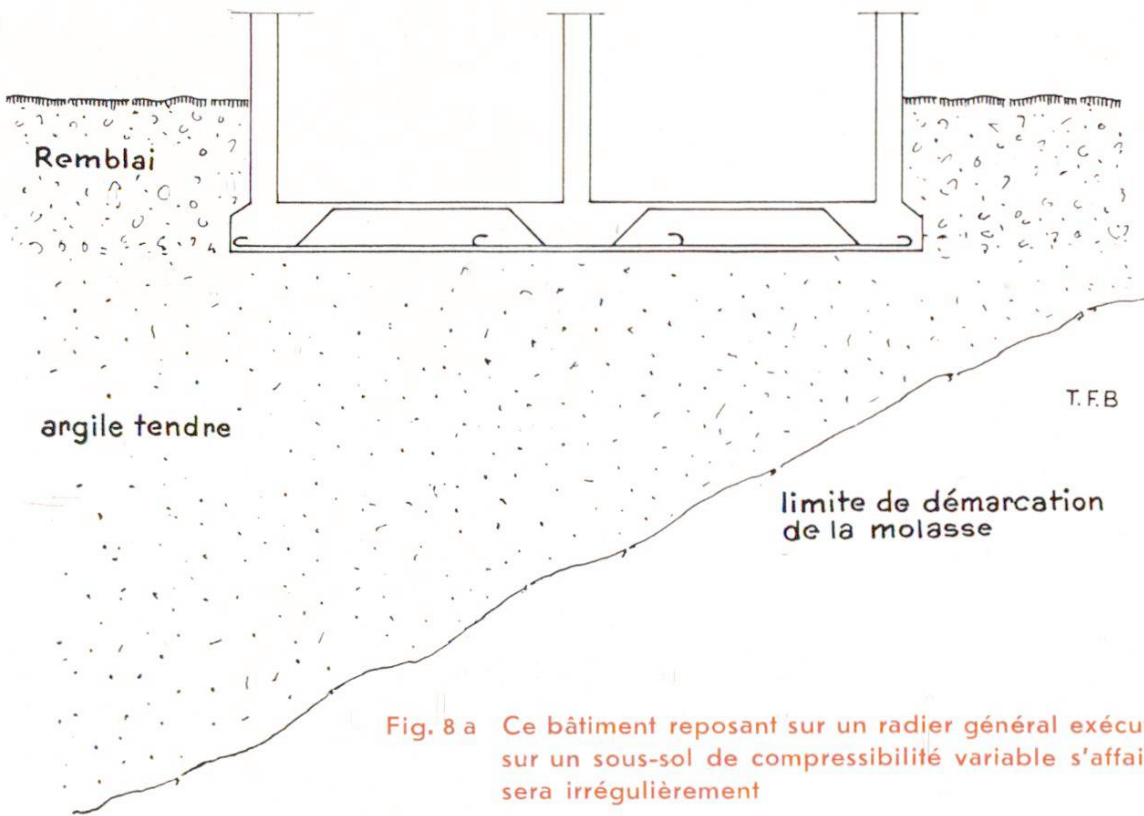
a Ce bâtiment reposant sur un radier général exécuté sur un sous-sol de compressibilité variable s'affaissera irrégulièrement
